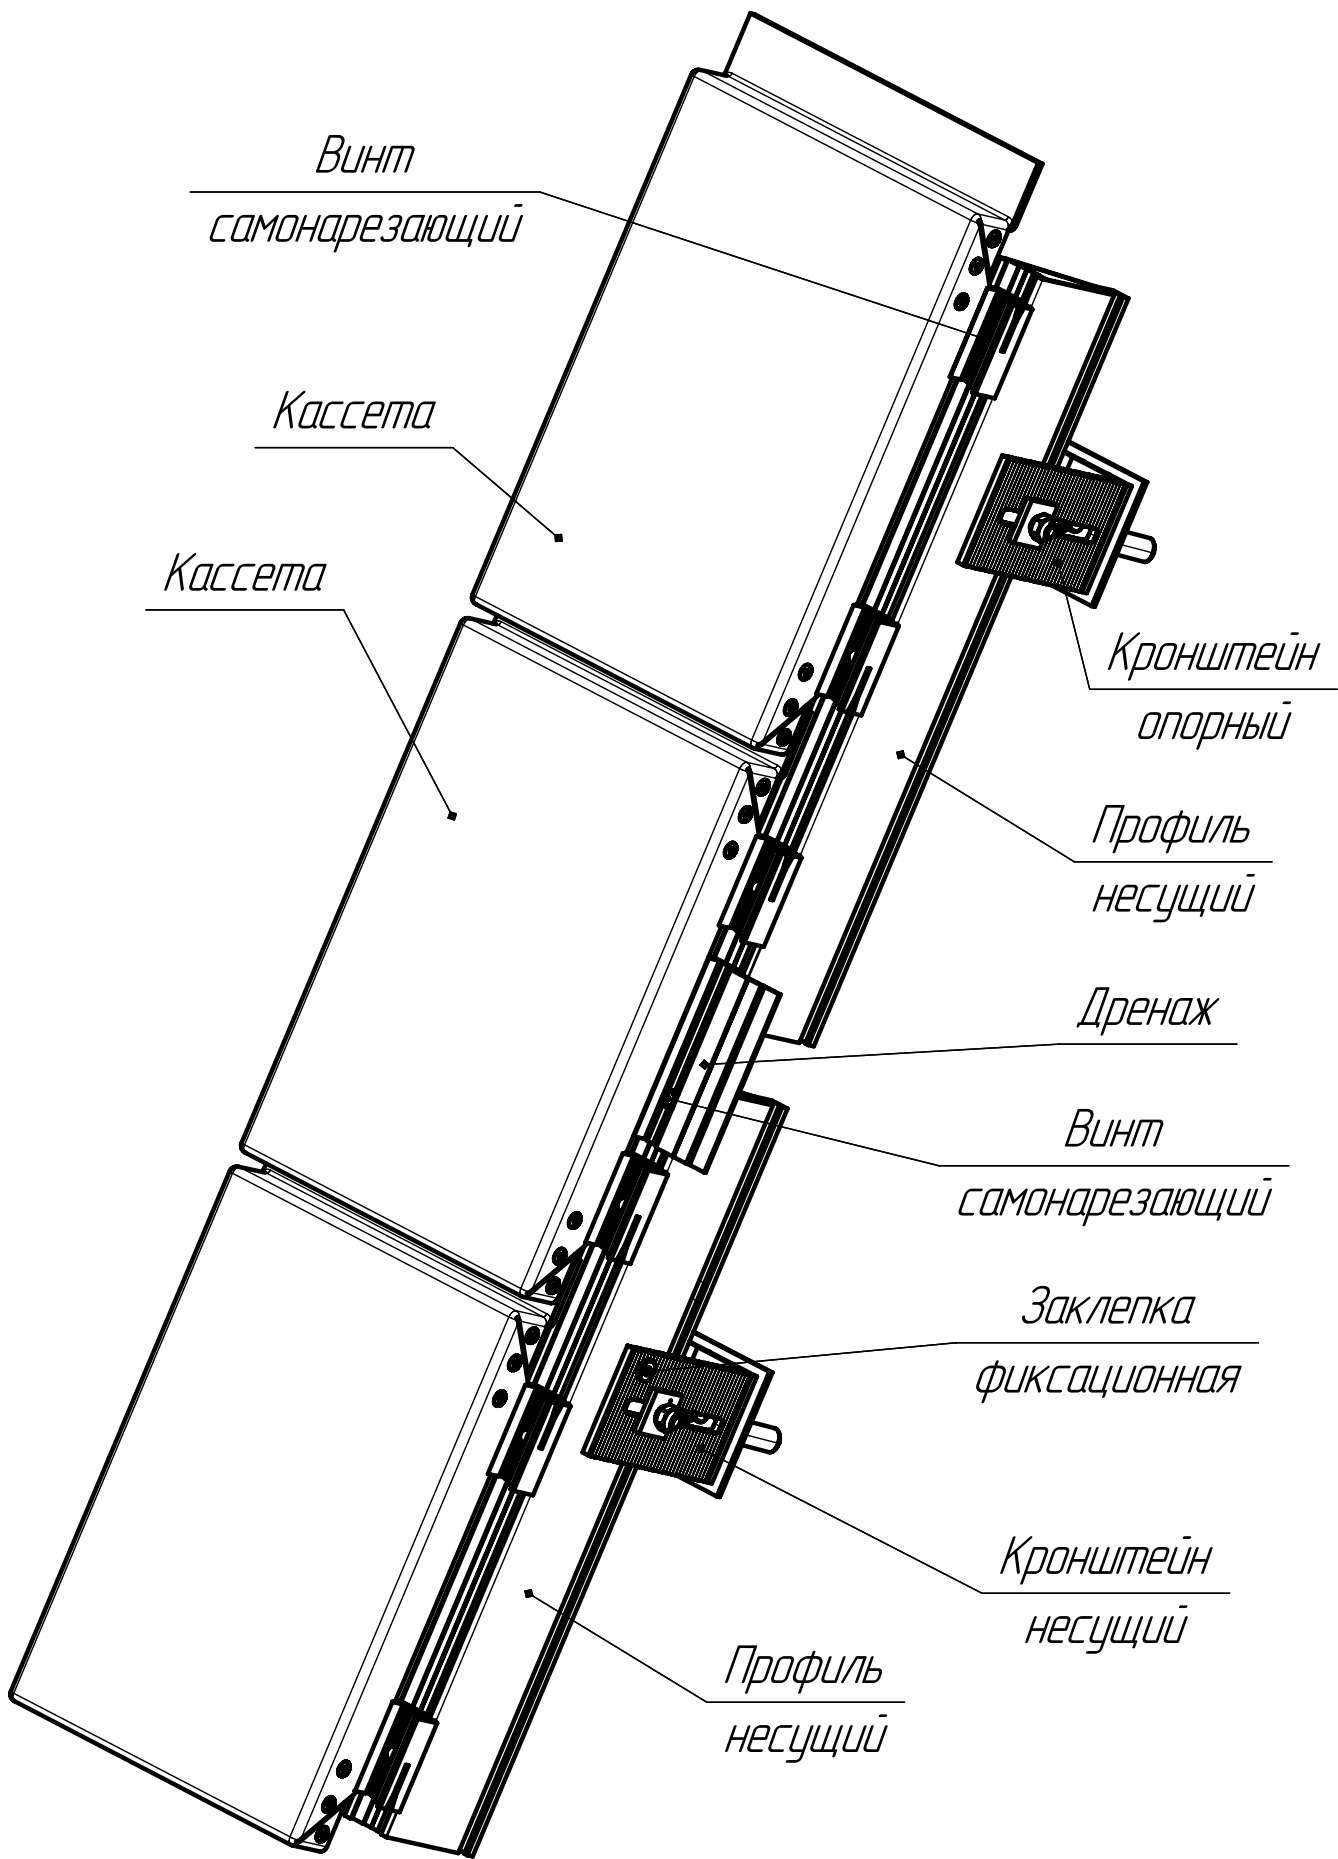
Схема монтажа облицовочных кассет на вертикальном участке стены
